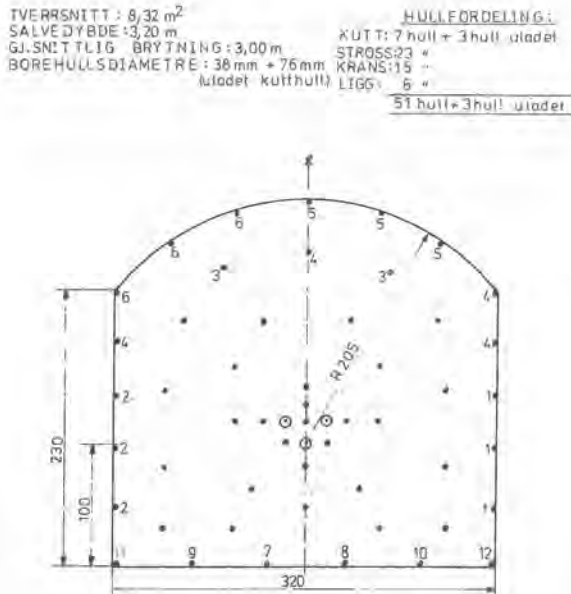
Salveplan. Tunnel Løkkebergvn. — Strøtvedt.
